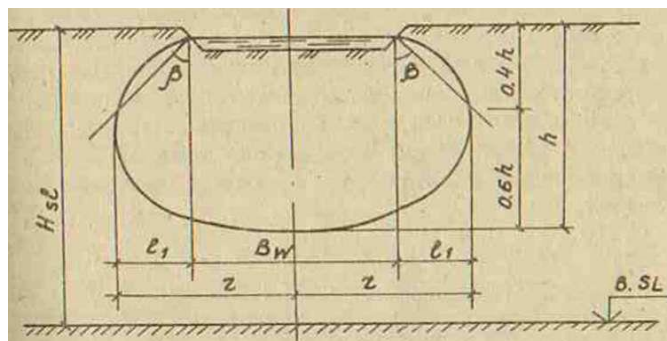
Схема увлажненной зоны при замачивании грунта из котлована  $B_w < H_{sl}$
